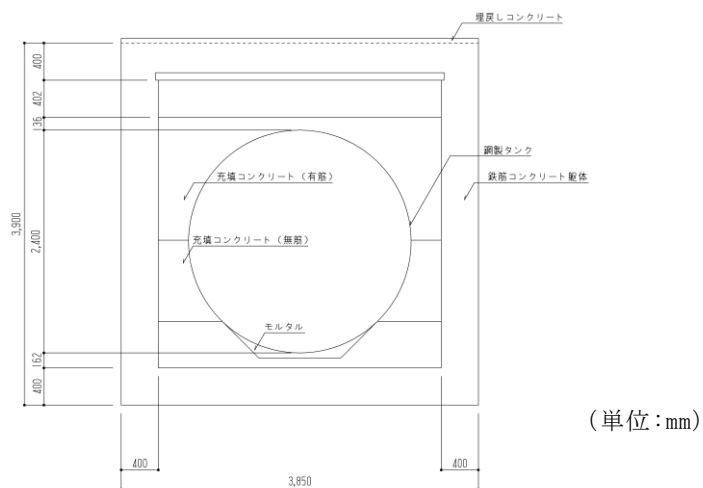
緊急時対策所用燃料地下タンク 断面図 (A-A断面)
